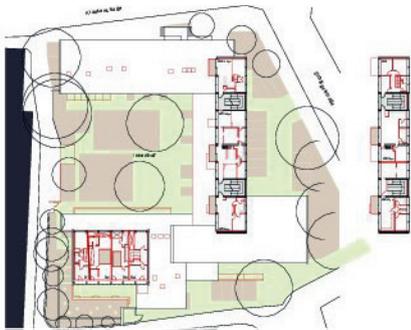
| Südstadtschule. Grundriss 1. Obergeschoß
